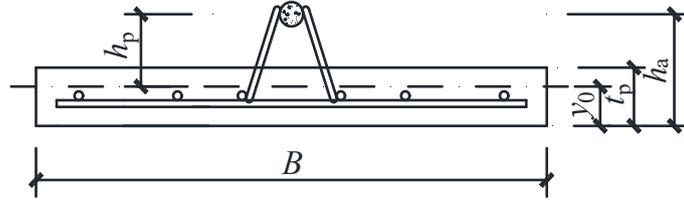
钢管桁架预应力混凝土预制底板组合截面示意
